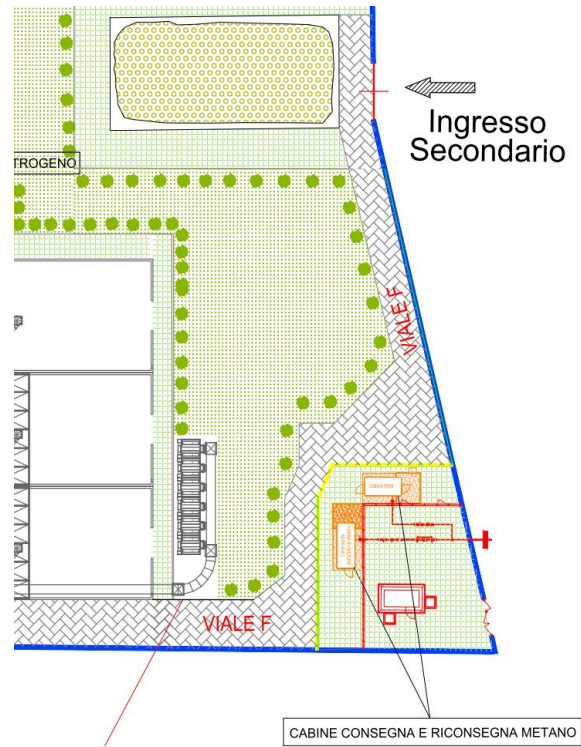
Stralcio SGI.0 Rev.4 recante la modifica progettuale del Viale F
